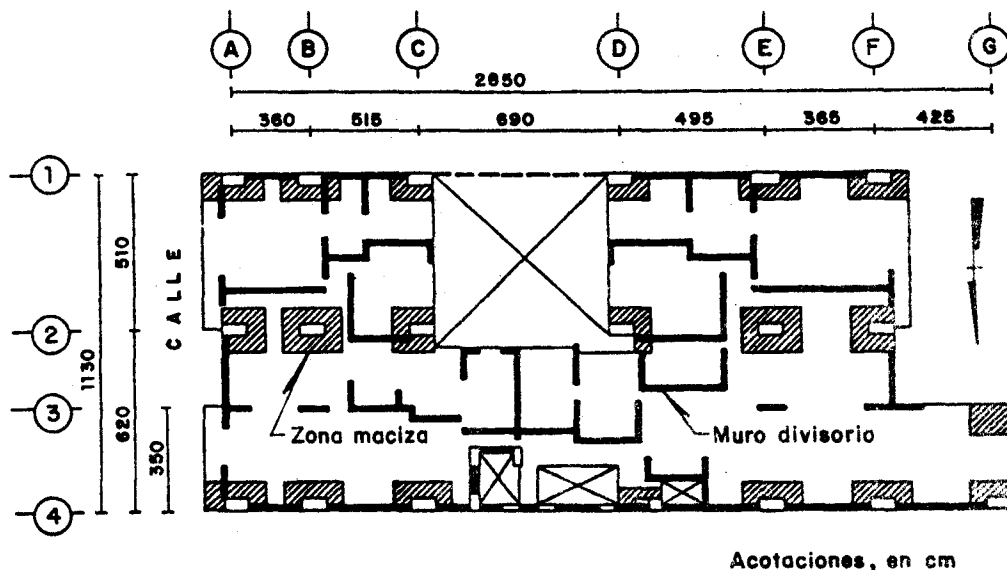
Edificio de departamentos de 10 pisos. Planta típica
